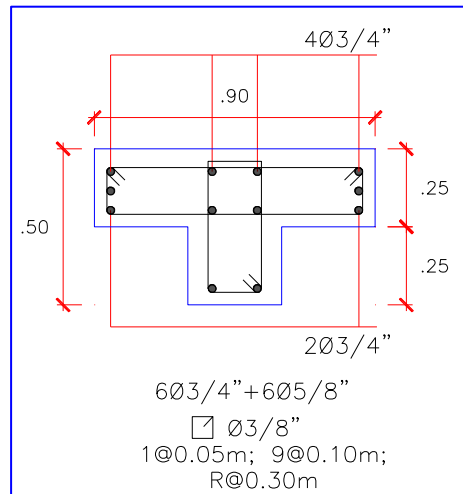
Distribución de acero en columna C2 y distribución de estribos
